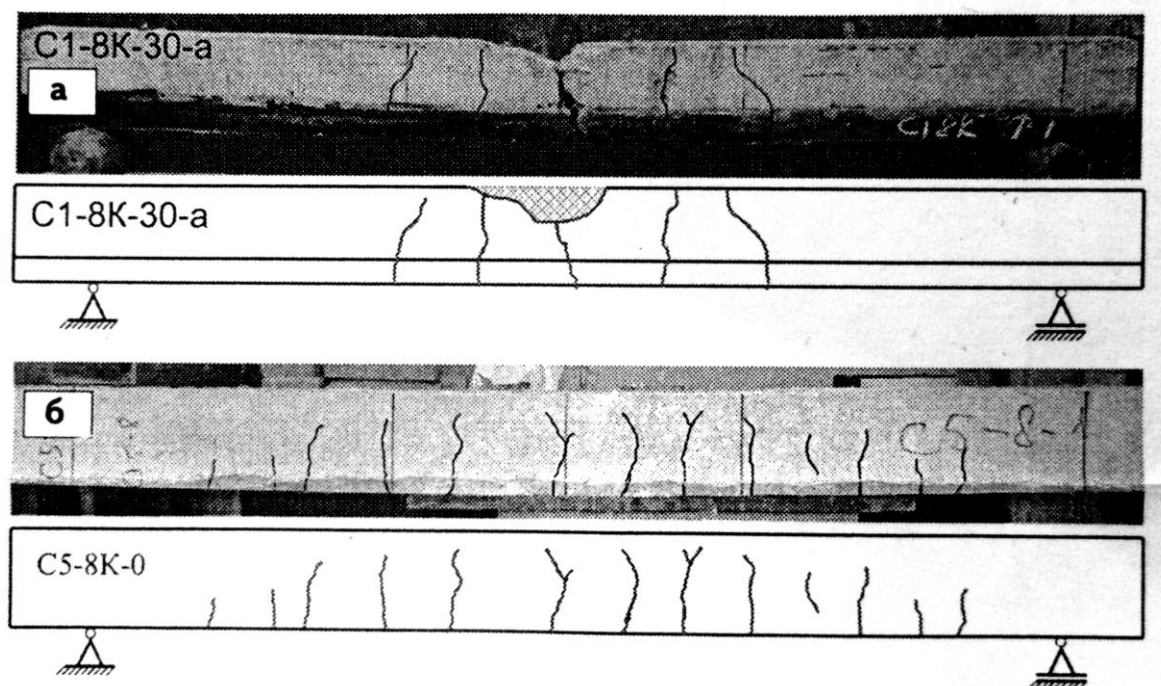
Схема расположения трещин: а – балка двухслойная полимербетонная; б – балка железобетонная
